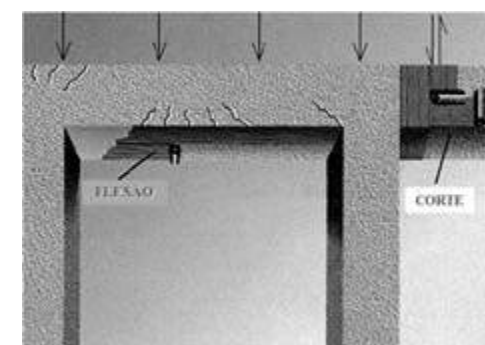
Reforço de vigas à flexão e ao corte.
